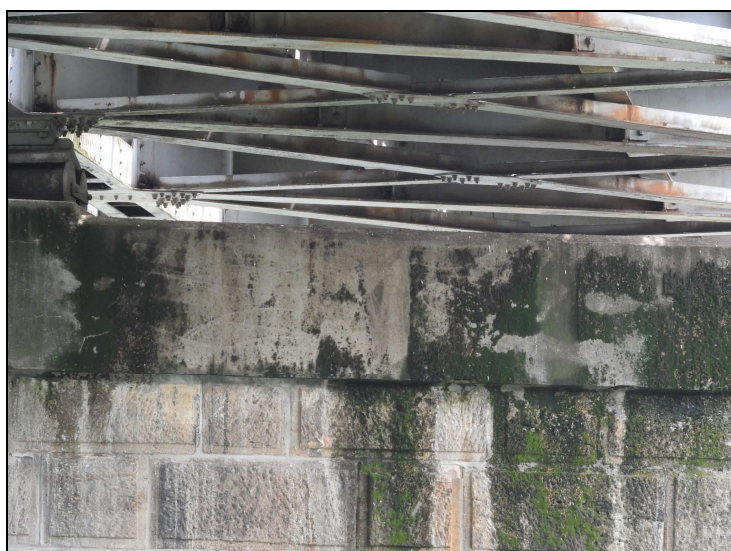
Pilíř P 03 – úložný práh – mech
